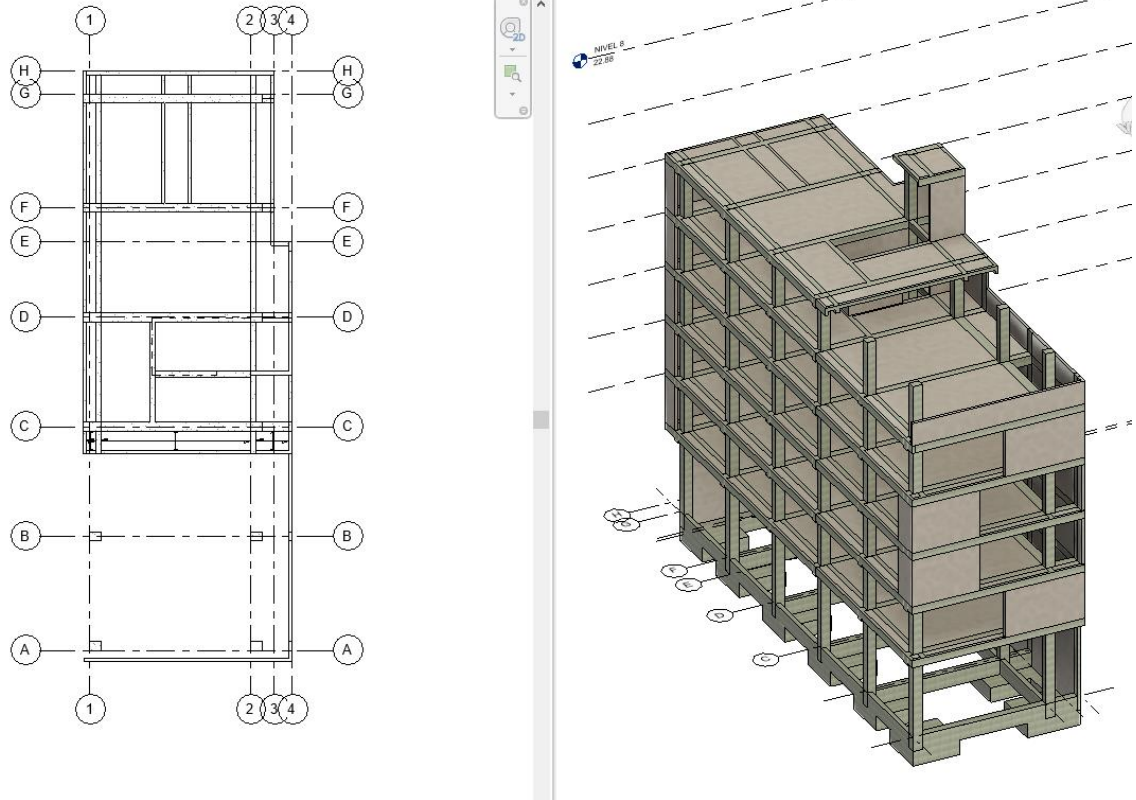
Lado izquierdo Vista de la planta del 6to Nivel y al lado derecho la vista en 3D de todos los niveles (Fuente: Elaboración Propia).
